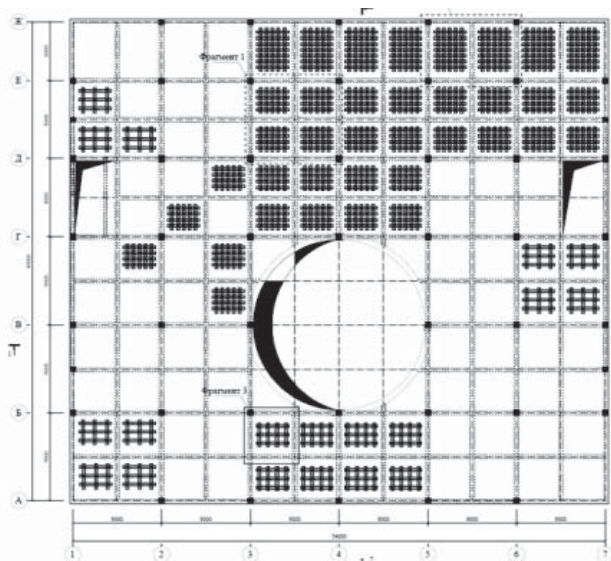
Схема усиления плиты перекрытия над верхним этажом полосами сеток
